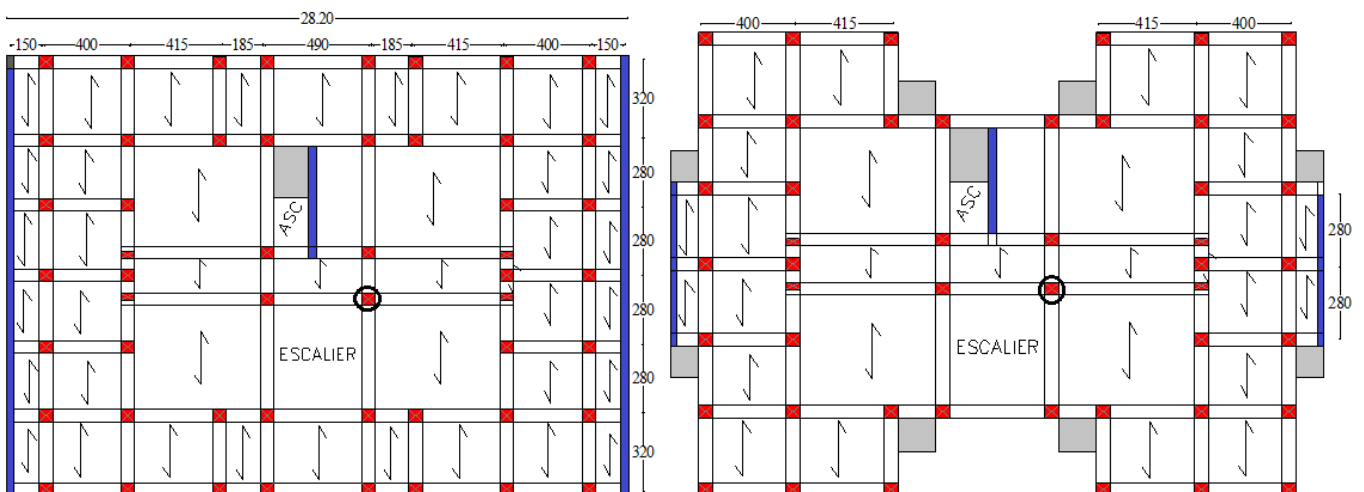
Schéma de la disposition des poutrelles pour l'entre sol et le RDC.
